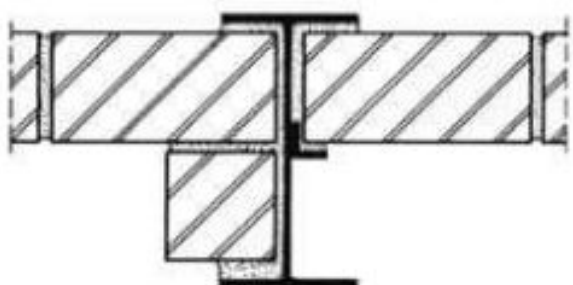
LIGAÇÃO DA ALVENARIA NA COLUNA. PAREDE DE 15 cm
